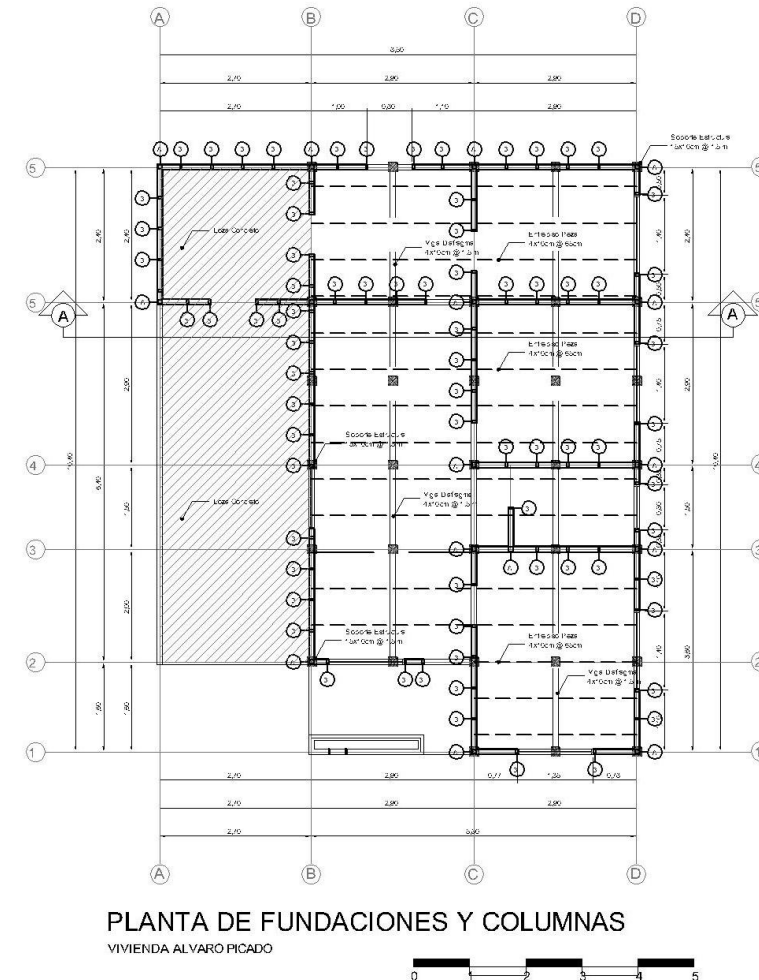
Planta Típica de Fundaciones y Columnas.
